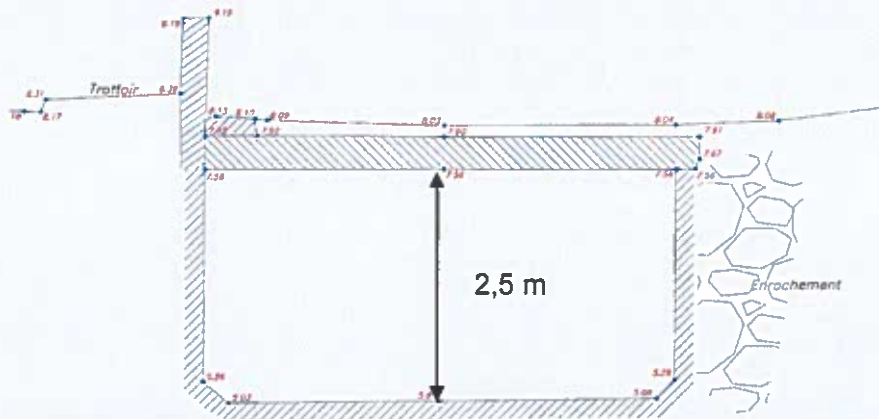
Coupe de l'ouvrage de franchissement de l'Altizana sous la RT 10
